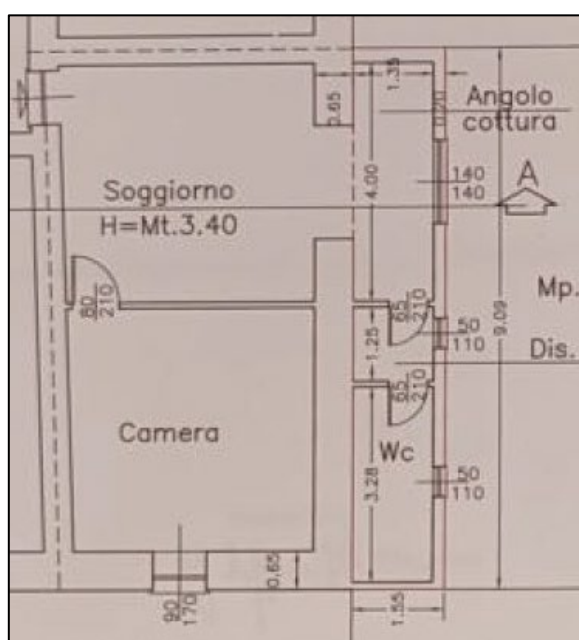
Planimetria allegata al PdC in sanat. 11.3.2010
